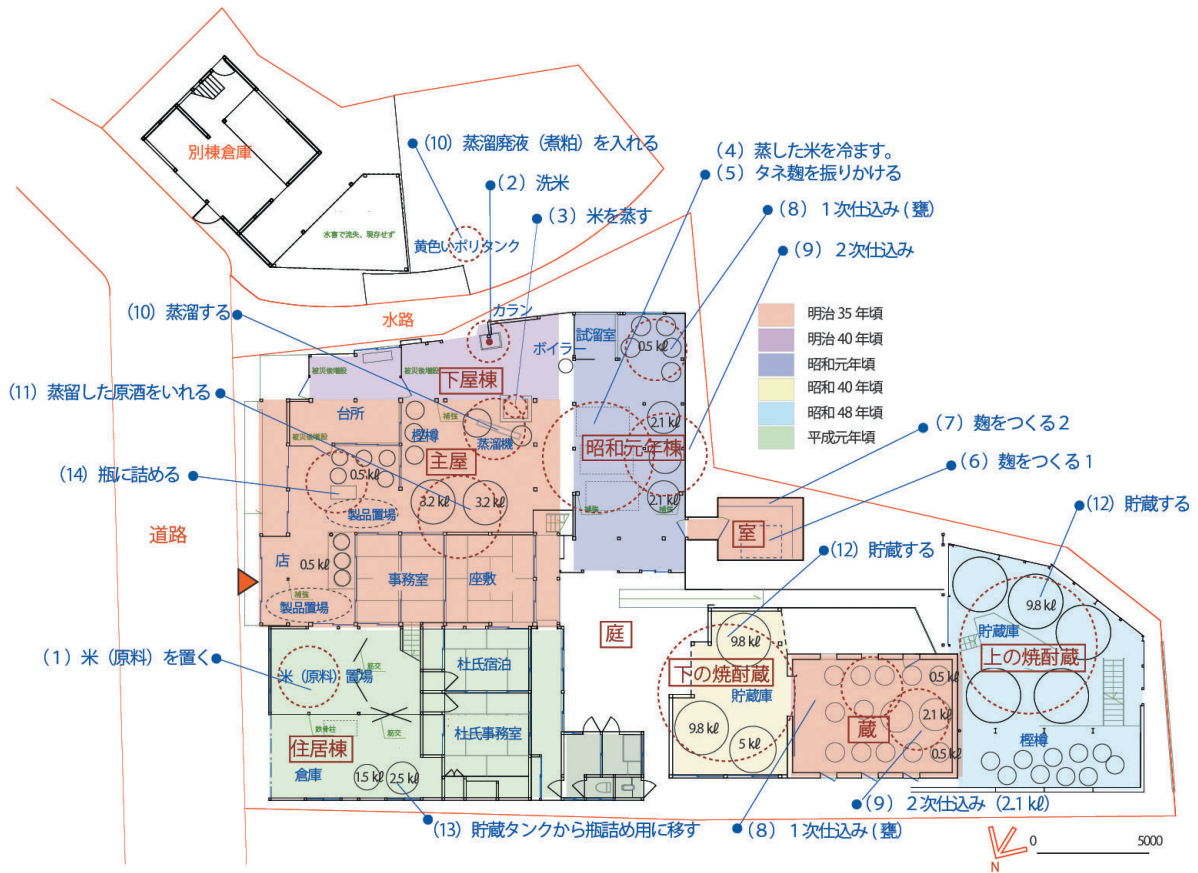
洩田酒造本店1階平面図兼配置図及び使われ方
